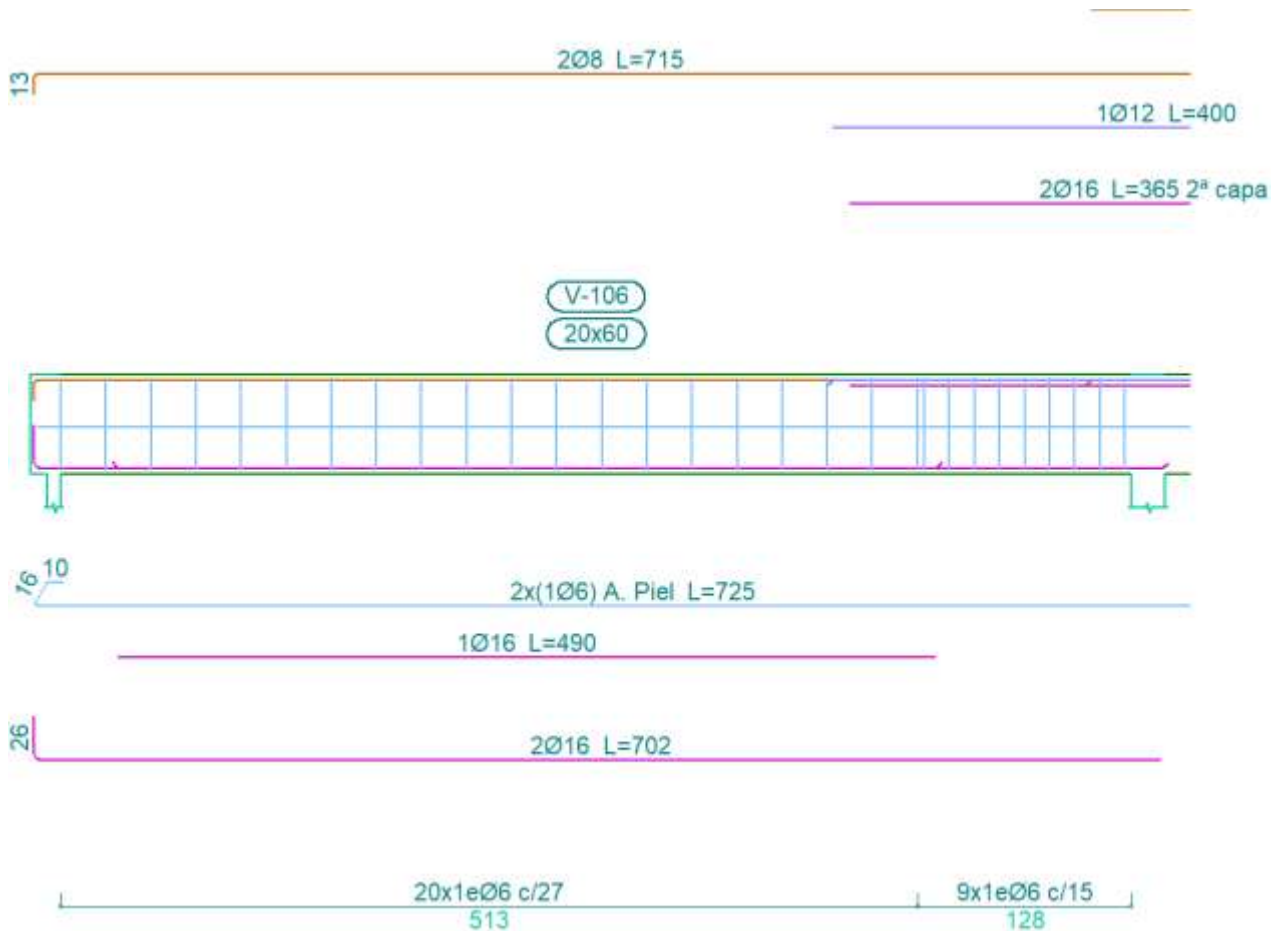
Detalle de armado viga tramo 1 (fuente: elaboración propia).
